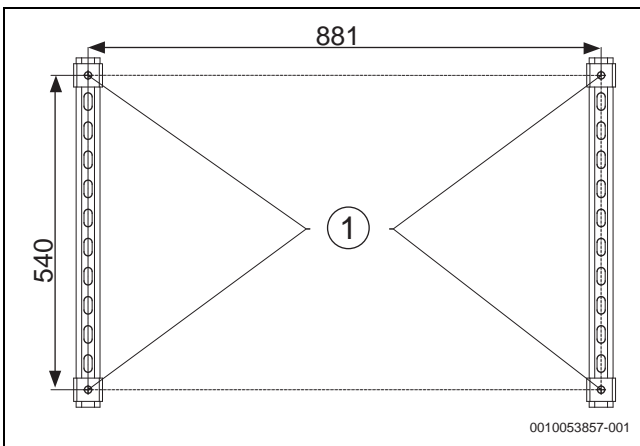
Mögliche Bohrpunkte Wandkonsole (Maße in mm)
